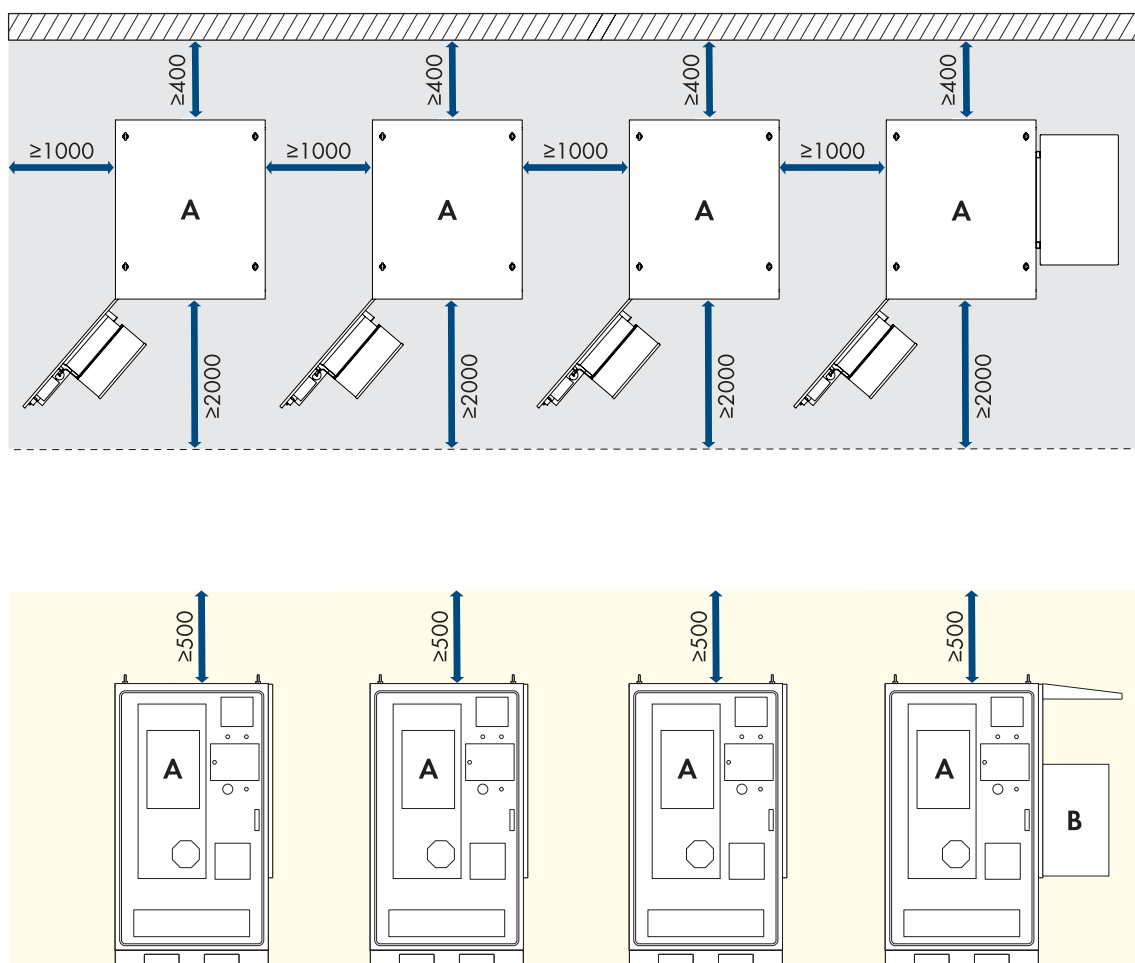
Esempio di installazione di un sistema con 4 armadi batterie (misure in mm)
